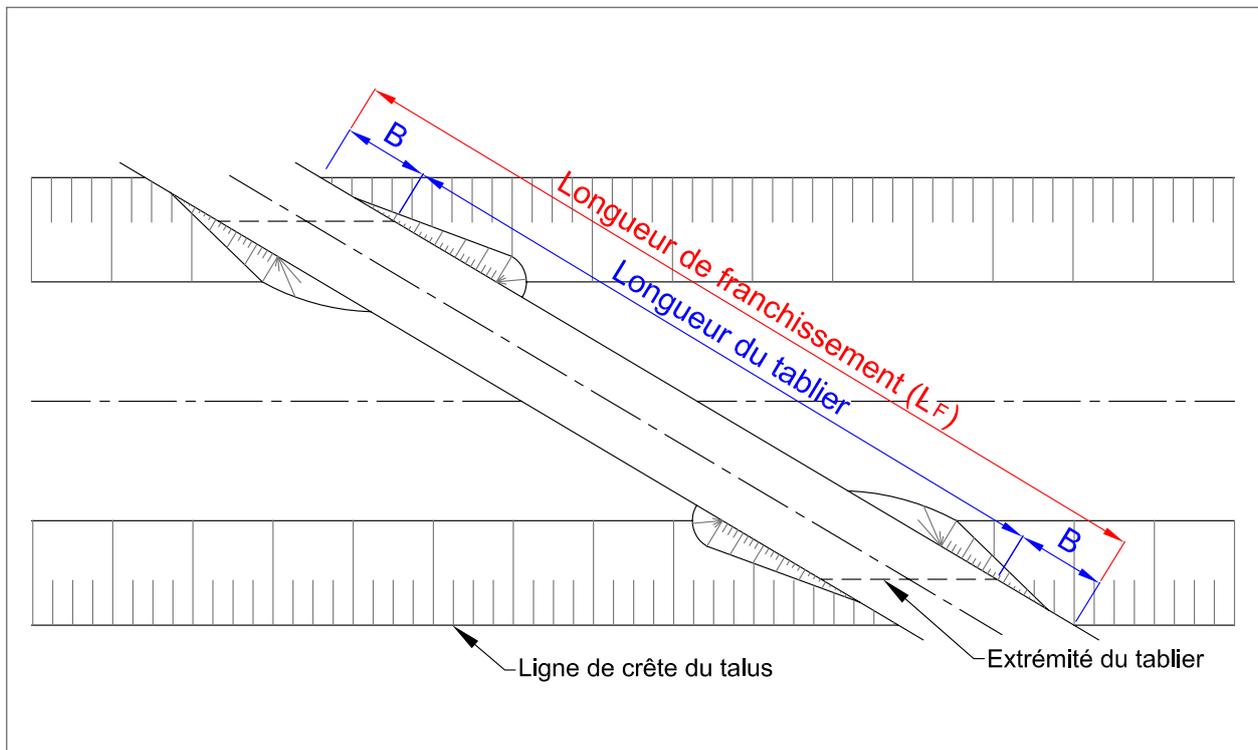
Longueur de franchissement  $L_f$  - Vue en plan
